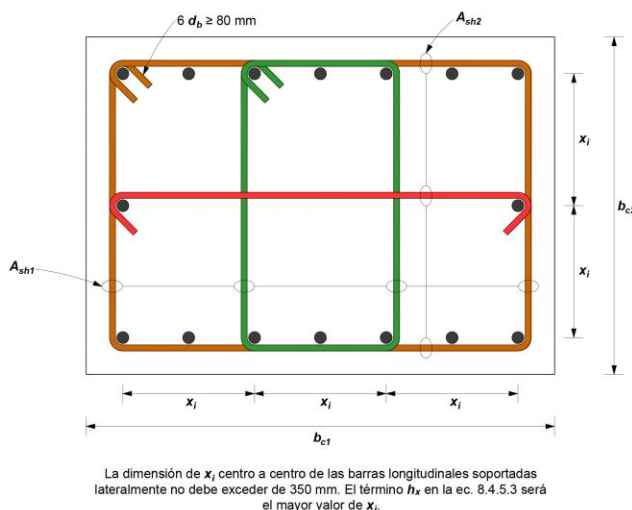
Ejemplo del refuerzo transversal en columnas (adaptada de ACI CODE-318-19)
